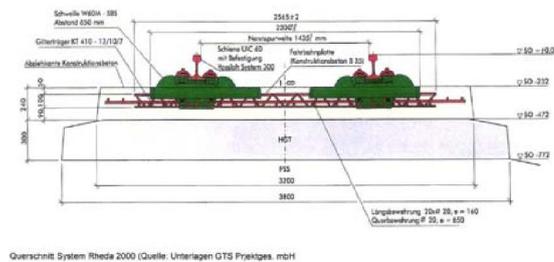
Extendido de traviesas y colocación de carril. Sección constructiva Rheda 2000.
